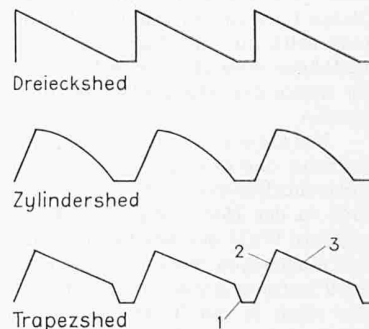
Drei typische Shedformen, Elemente des Trapezshed: 1 V-förmiger Rinnenträger, 2 Stahlstützenkonstruktion in den Fensterebenen, 3 Dachplatte
